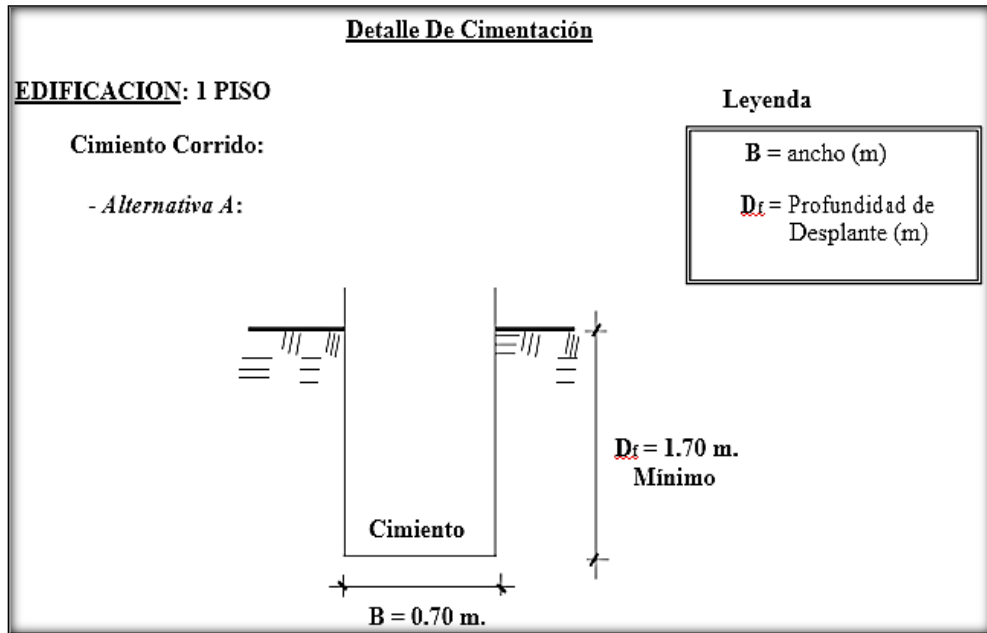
Detalle De Cimentación (Estudio de Suelos)
